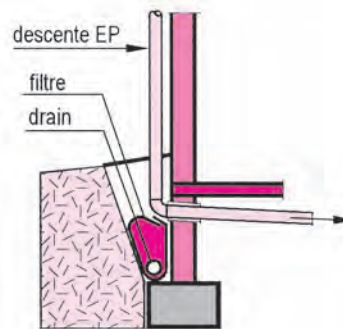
Traversée de mur pour eaux pluviales avec {fourreau + étanchéité}
